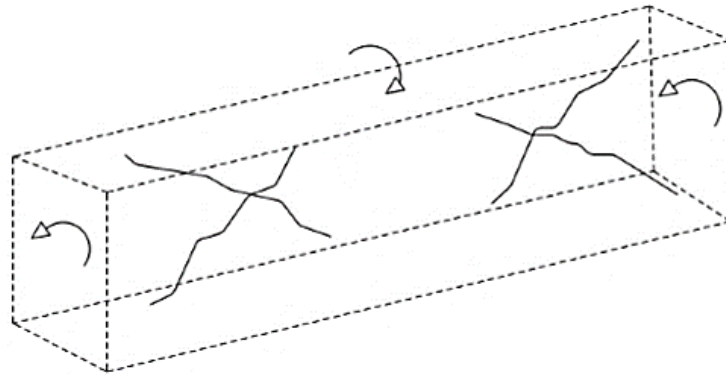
Ruptura por flexão da armadura longitudinal
